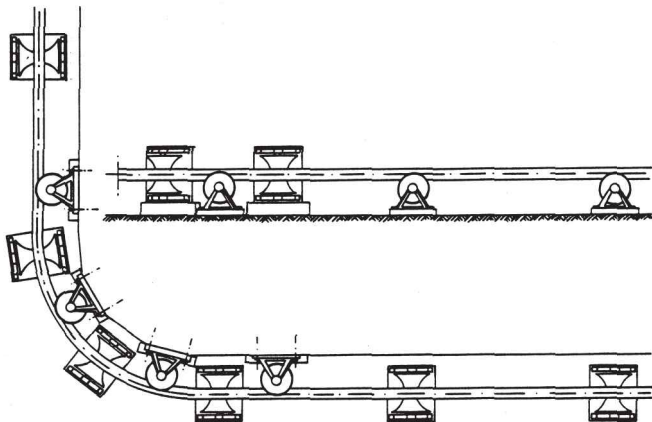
Disposición de los rodillos para el tendido de cables.
